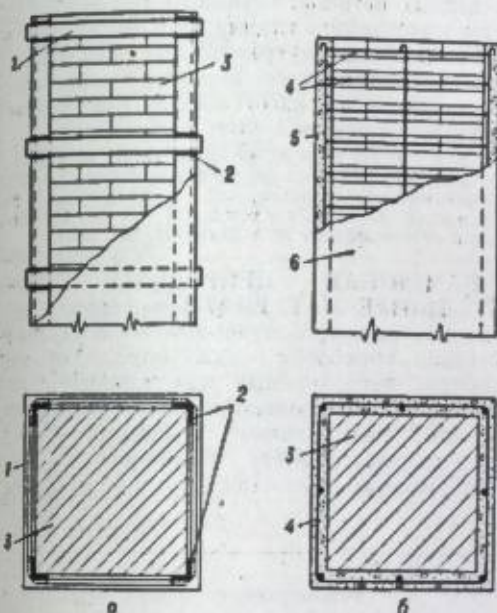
Усиление каменных столбов и простенков обоймами: а — стальная обойма; б — железобетонная обойма; 1 — приварные планки (хомуты); 2 — уголки; 3 — кладка; 4 — хомуты; 5 — вертикальная арматура; 6 — слой бетона.
